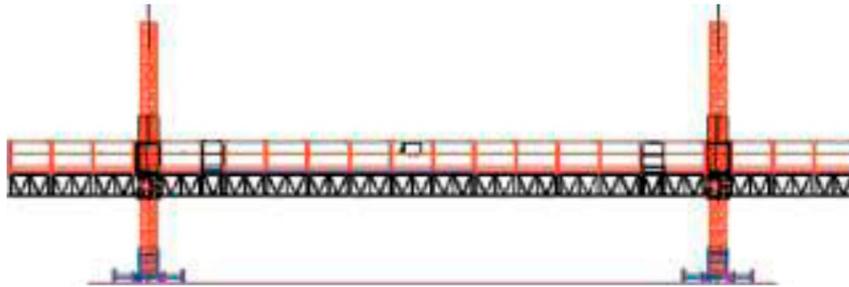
Plataforma elevadora sobre dos mástiles que permite el desplazamiento vertical de la plataforma de trabajo.
